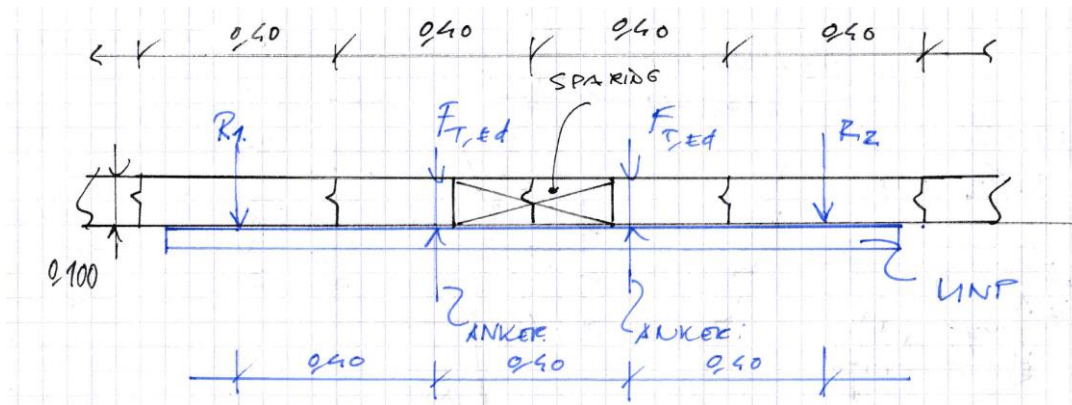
Uitgangspunten berekening reactiekracht bovenkant doorboorde damwand
